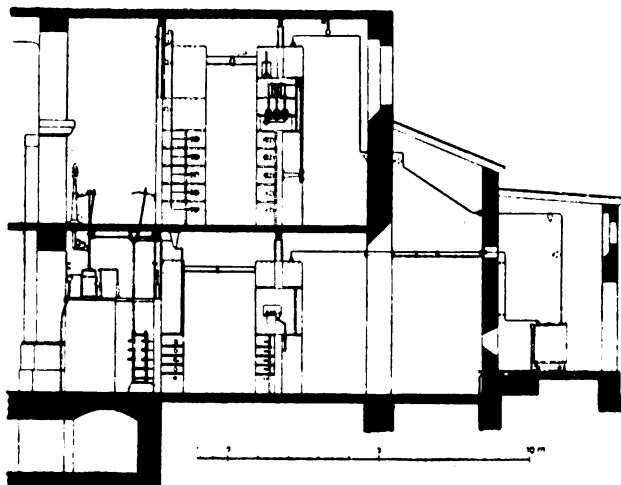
Coupe transversale de l'usine génératrice. Échelle : 1/250.
